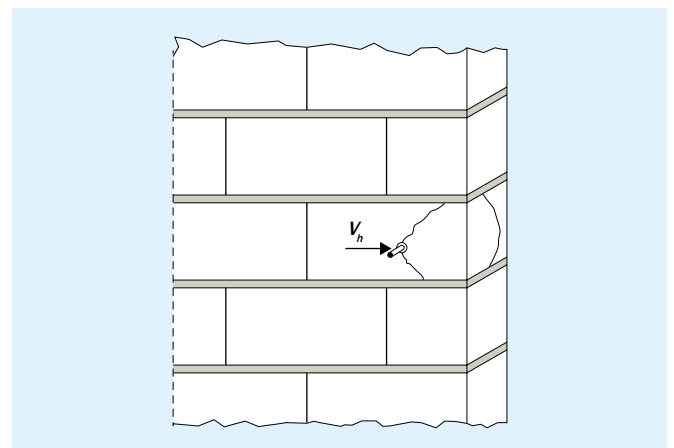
Steinkantenbruch am Mauerwerksrand [9]
